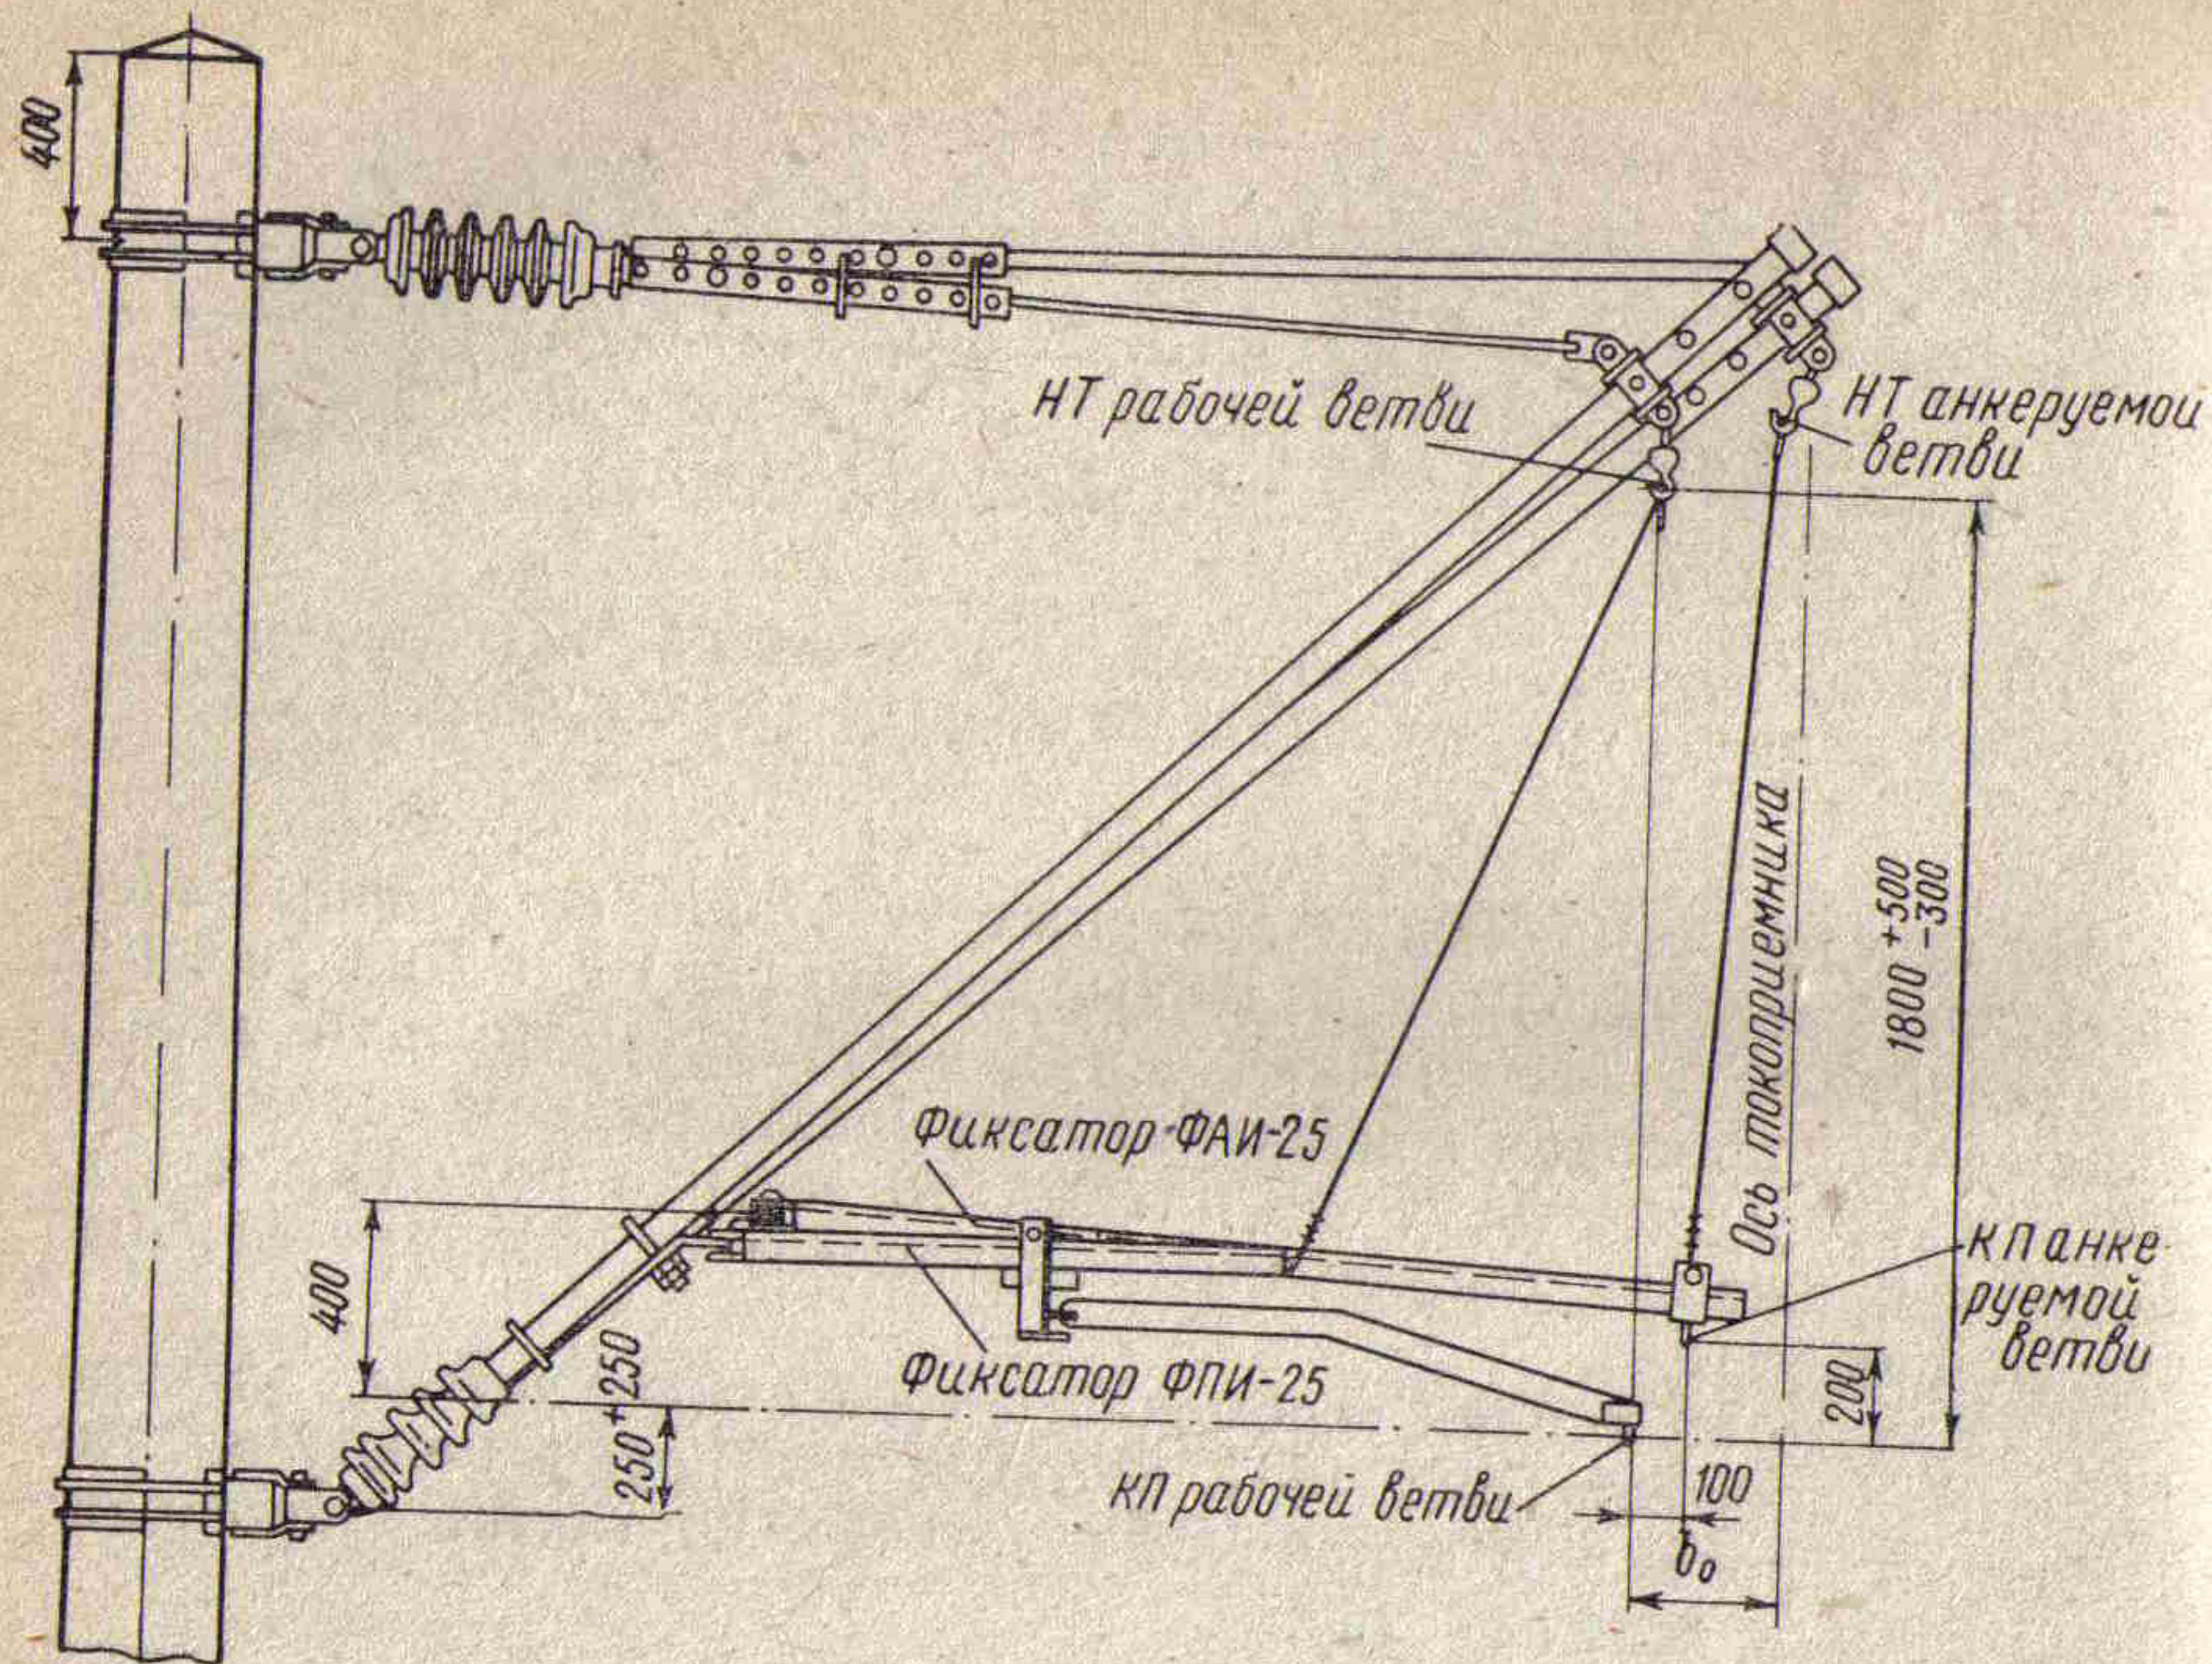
Армирование переходной опоры неизолирующего сопряжения анкерных участков на прямом участке пути линии переменного тока
